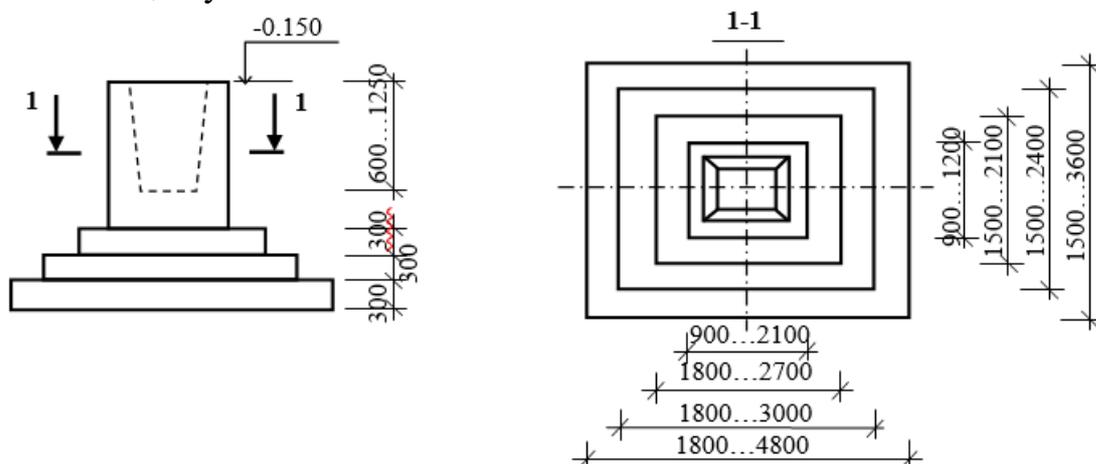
Монолитный фундамент под железобетонные колонны
